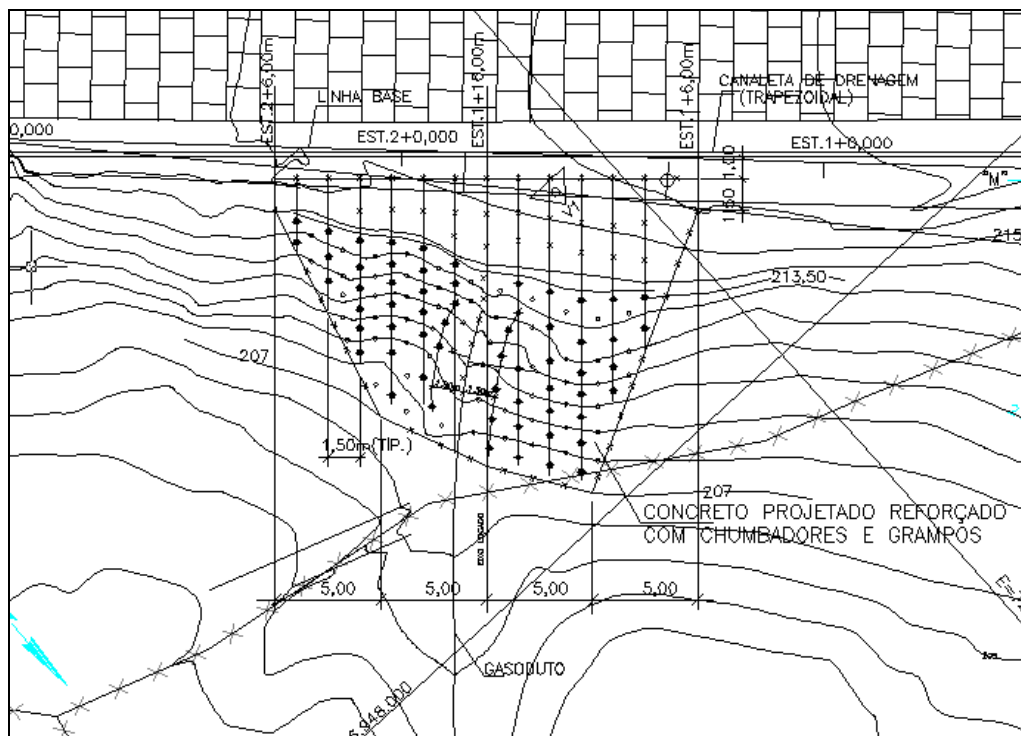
Projeto de estabilização em solo grampeado – Planta Baixa.
